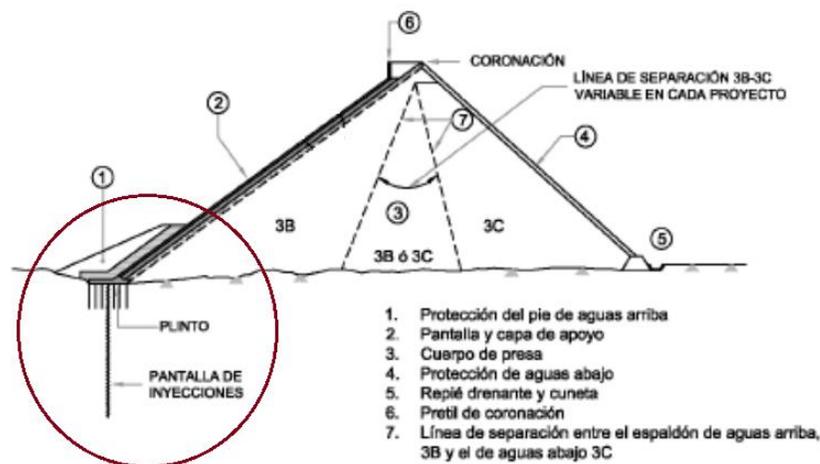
Sección tipo de presa CFRD con detalle de fundaciones y plinto.
